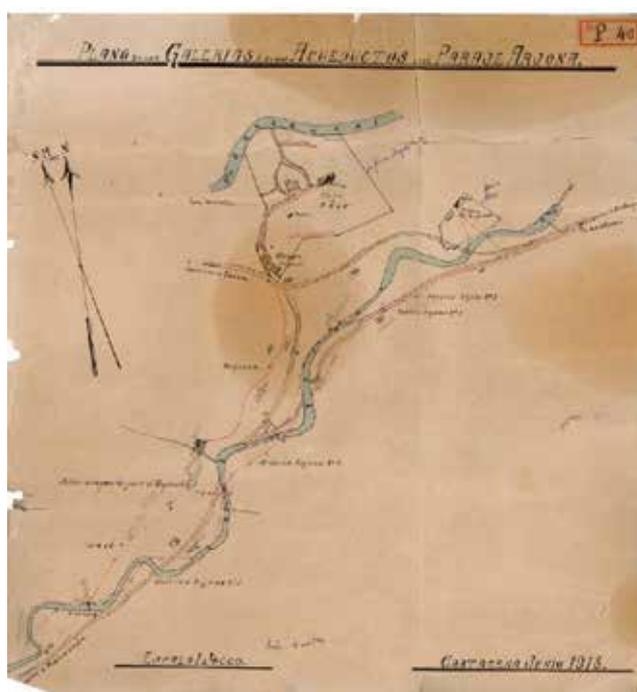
Plano de las galerías y de los acueductos del paraje de Arjona, de 1918
